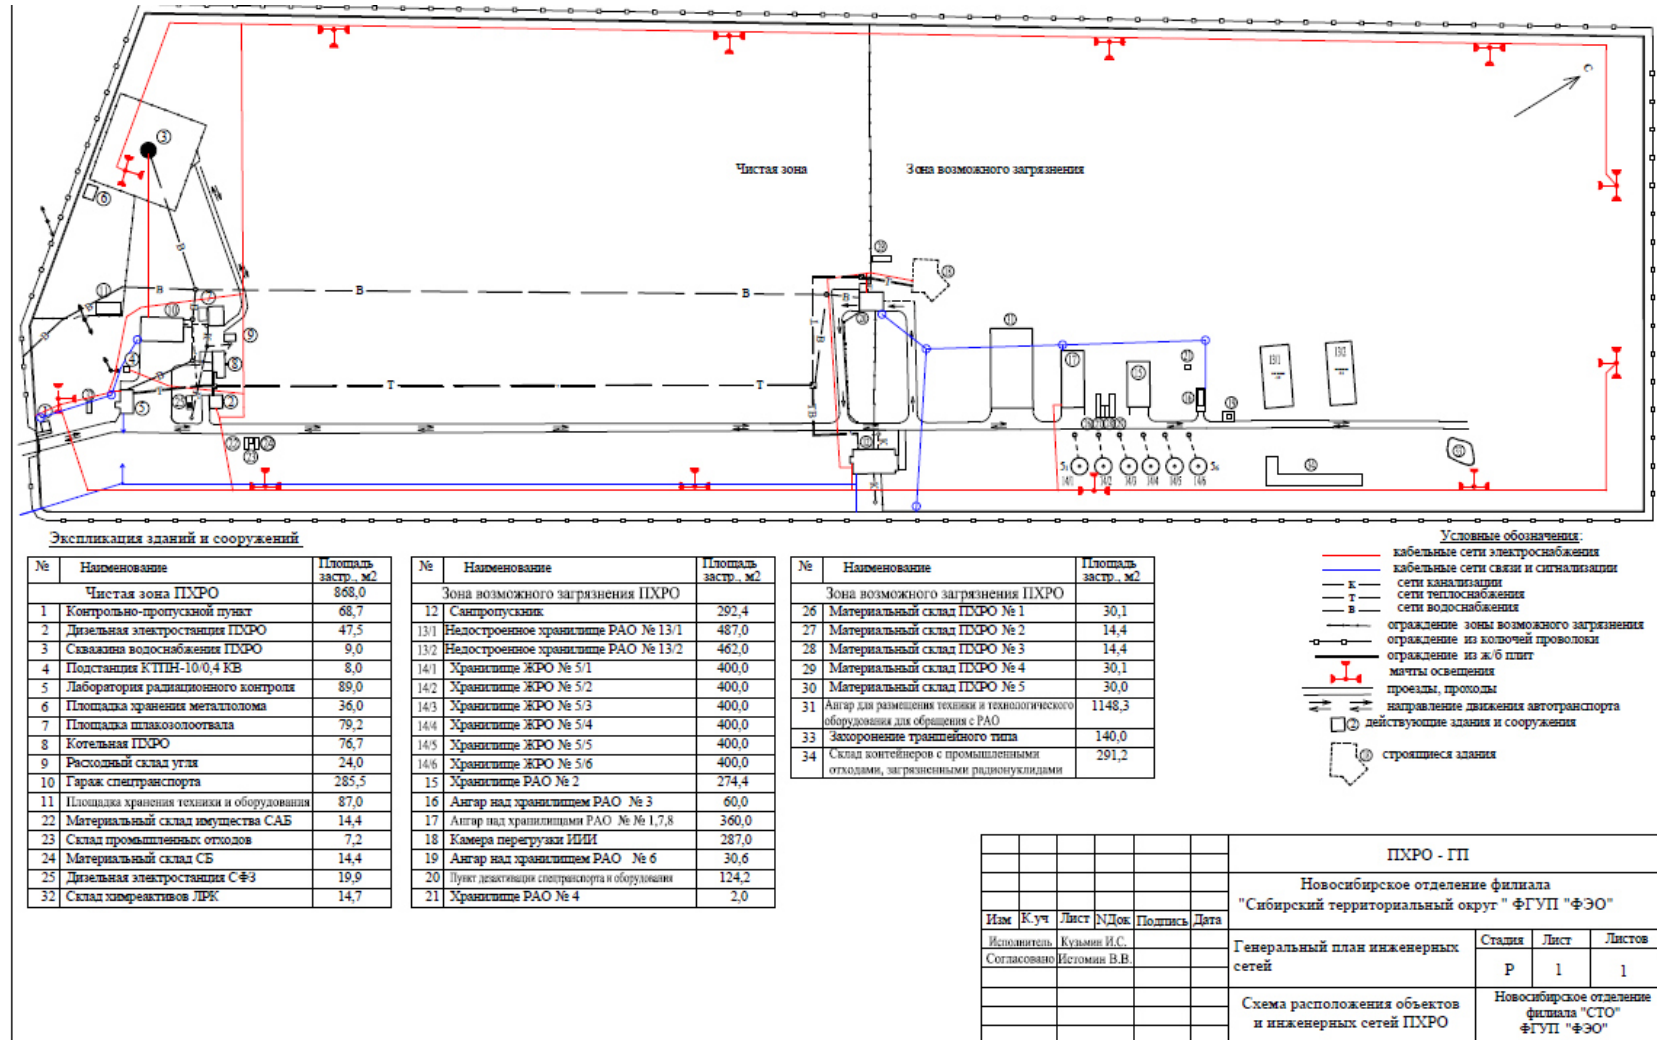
Схема водопотребления и водоотведения площадки ПХРО
